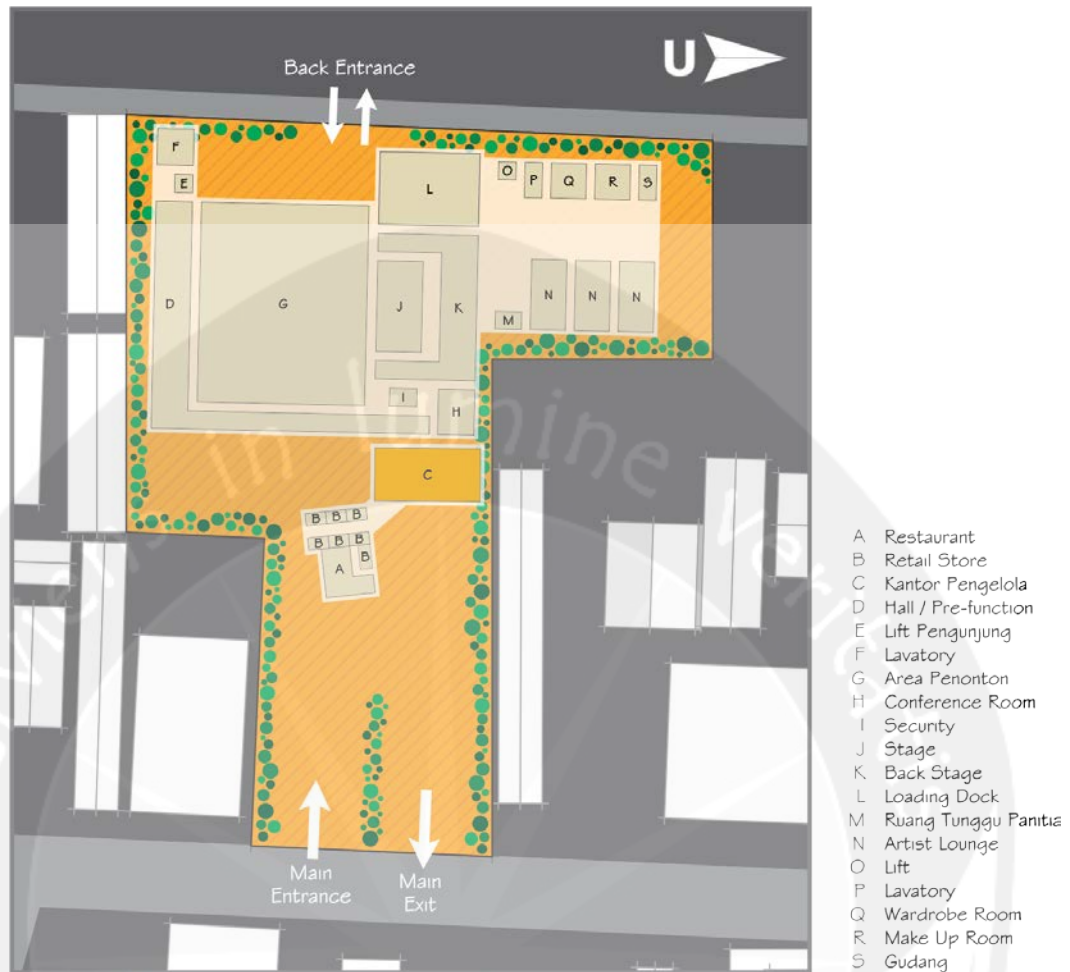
Konsep Tata Ruang Bangunan – Lantai Bawah
